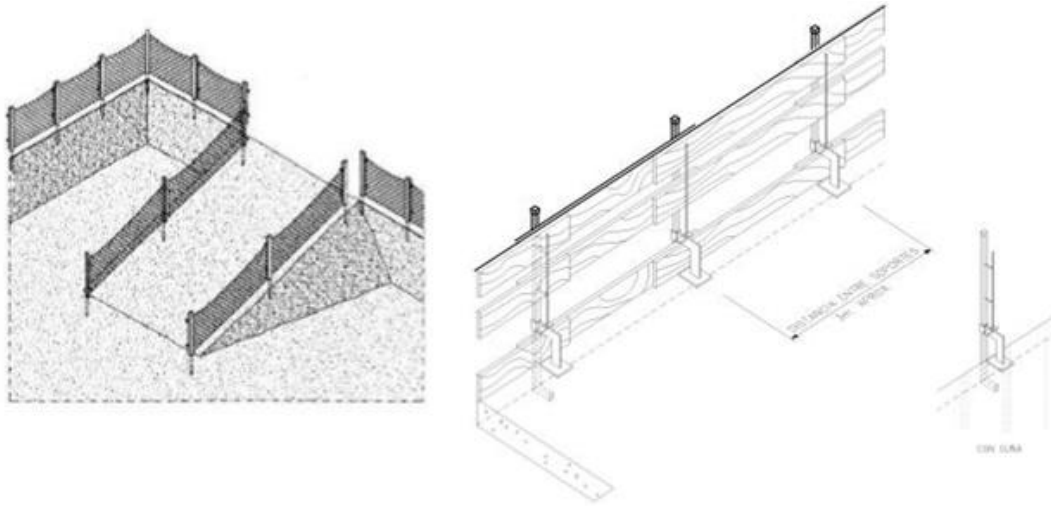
Detalles de protección taludes de excavación. [Elaboración propia]
